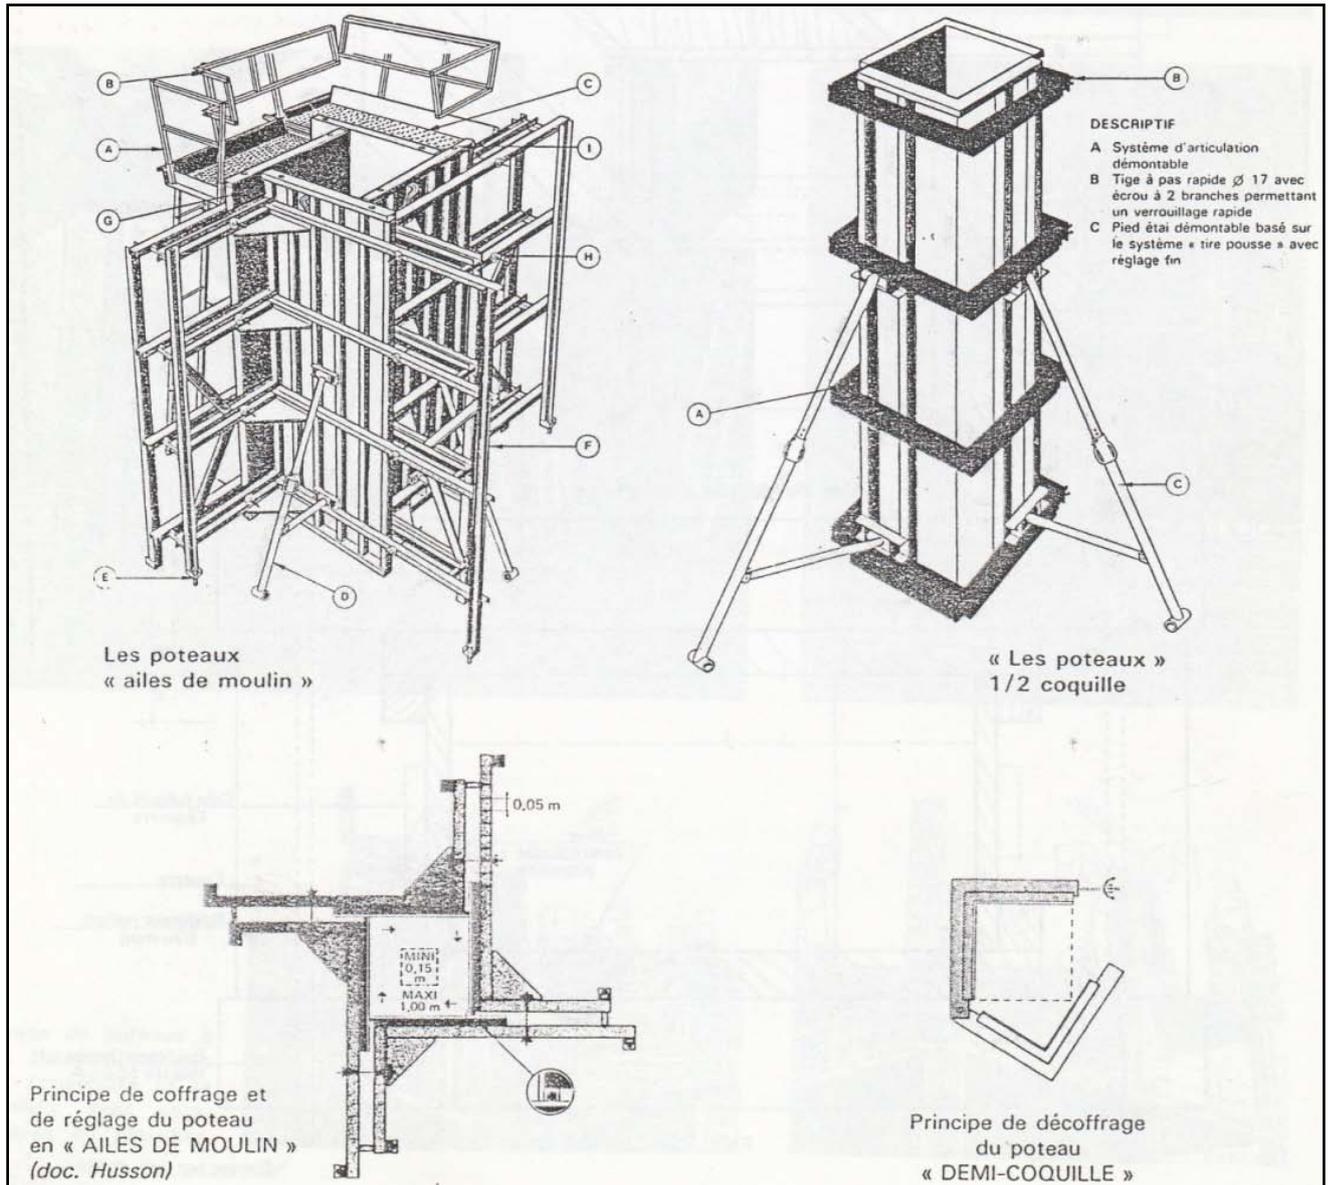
coffrage en demi-coquille et en aile de moulin d'un poteau carré
